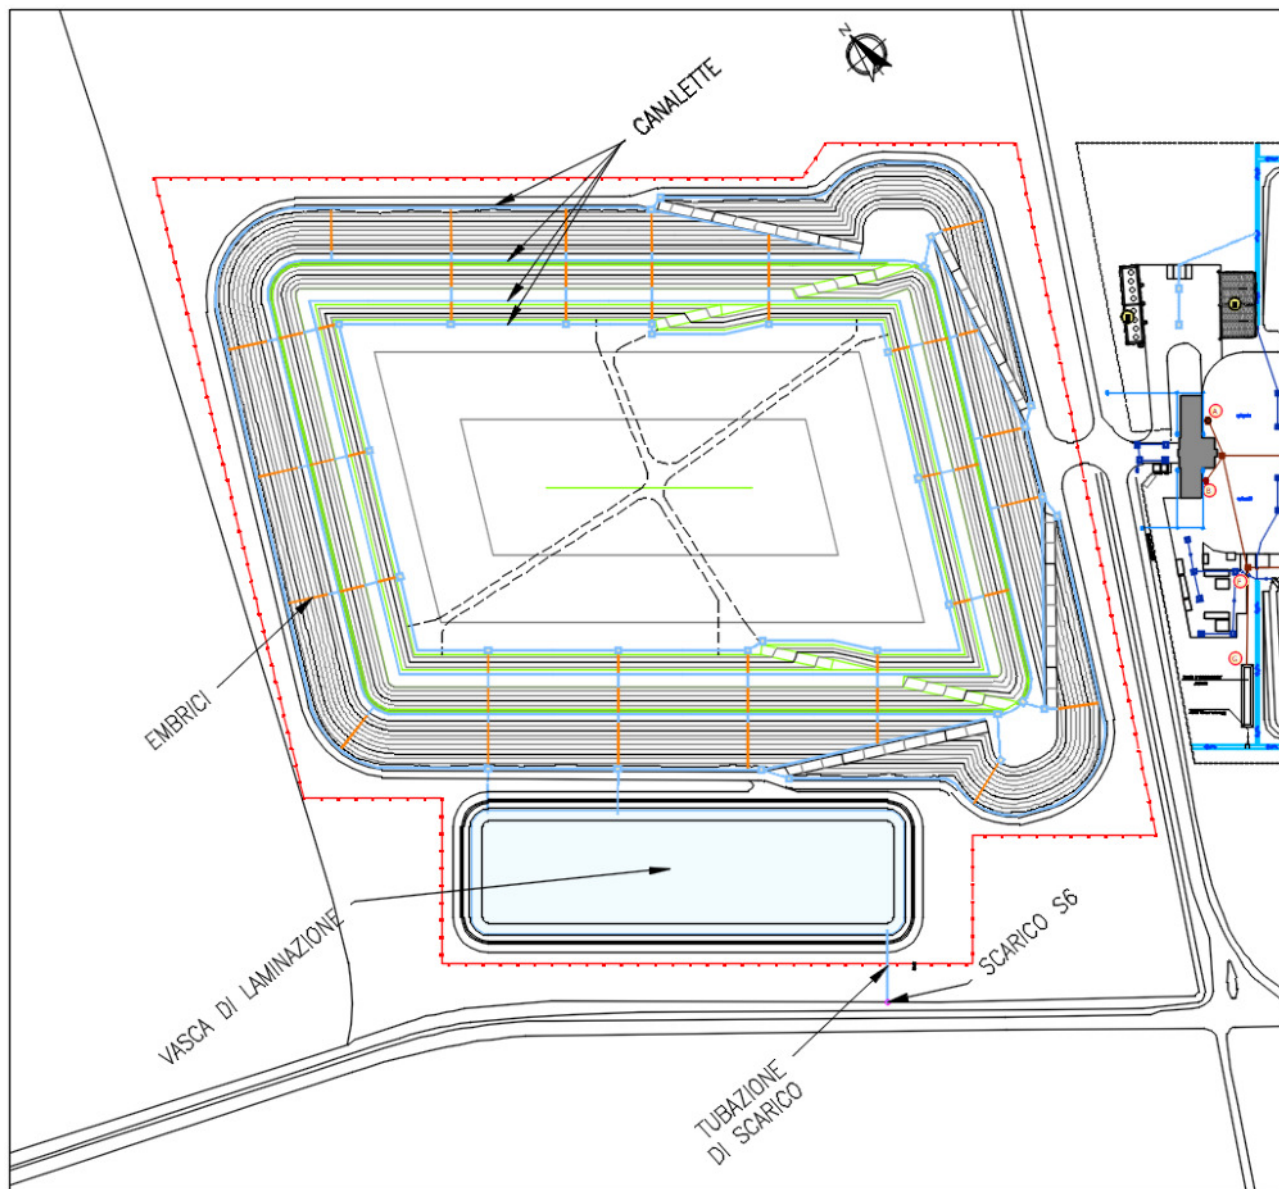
Planimetria con schema della rete di controllo delle acque meteoriche
